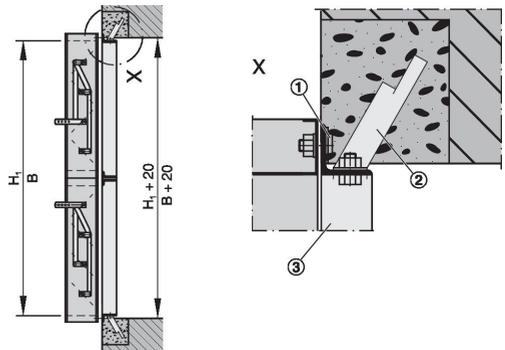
Wandanbau mit Einbaurahmen Höhe-
